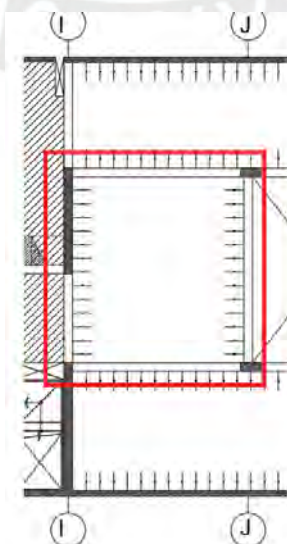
Sección de la losa aligerada a analizar
